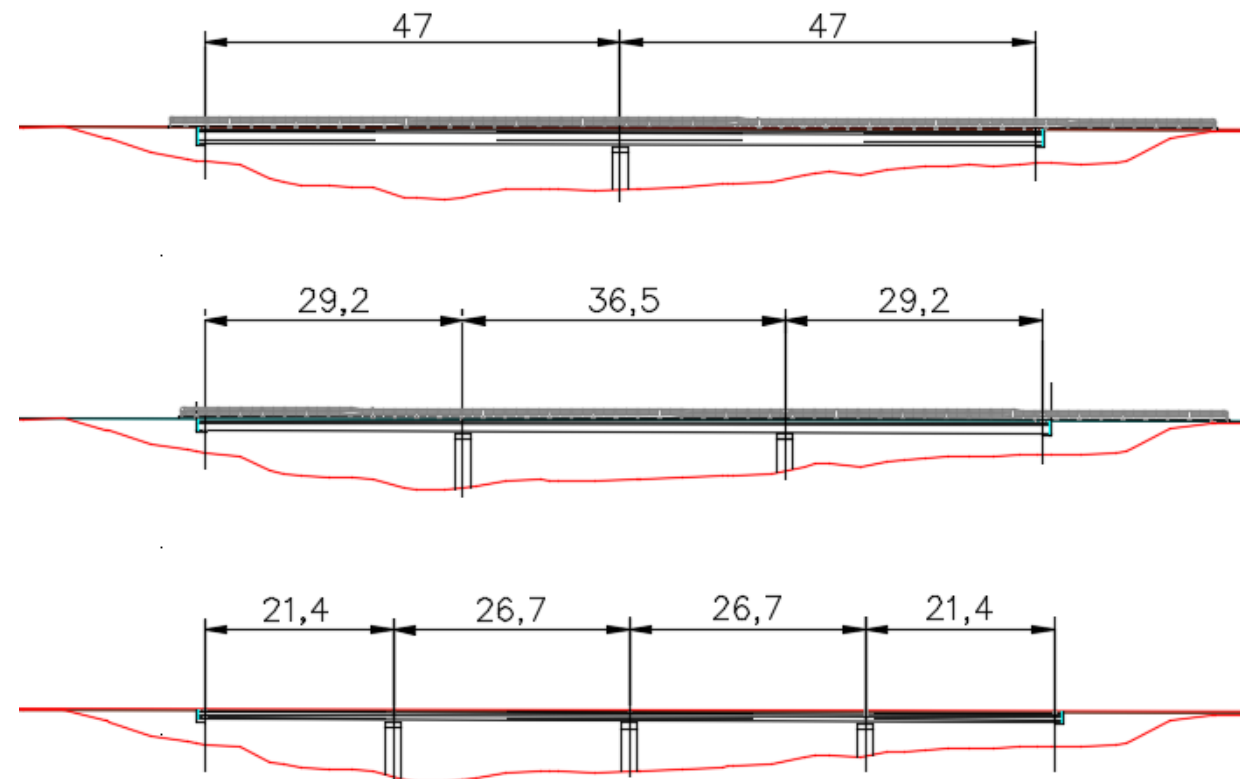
Perfil sección losa 2, 3 y 4 vanos
